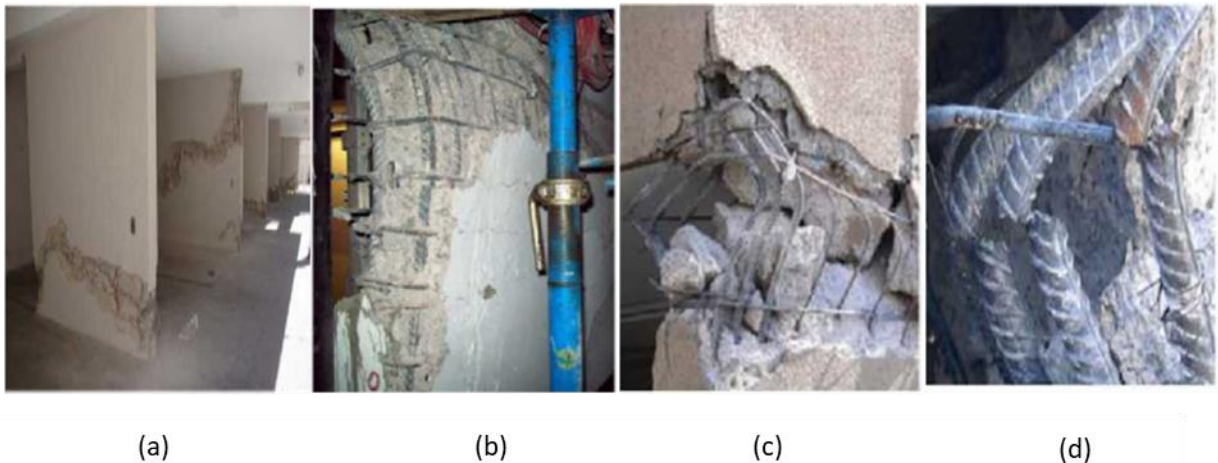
Tipos de daño observados en muros durante el terremoto en Chile de 2010. Daño general en los muros del primer nivel (a); Inestabilidad (b); Pandeo del refuerzo longitudinal (c); Corte del refuerzo longitudinal (d) (Adaptada de Wallace, Massone et al. [2]).
